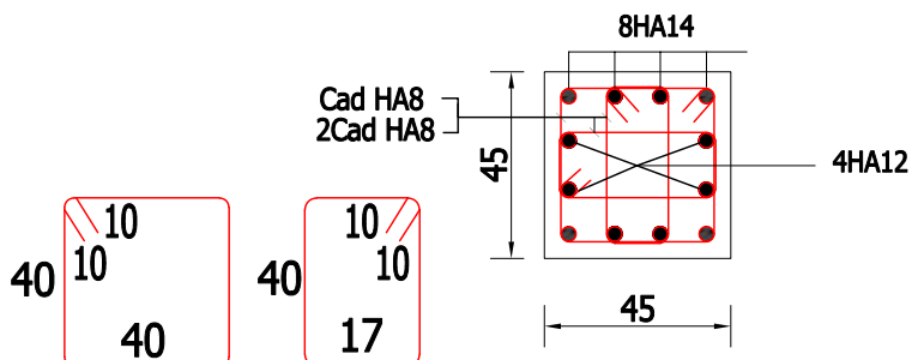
Schéma ferrailage Poteaux (45 x 45)
